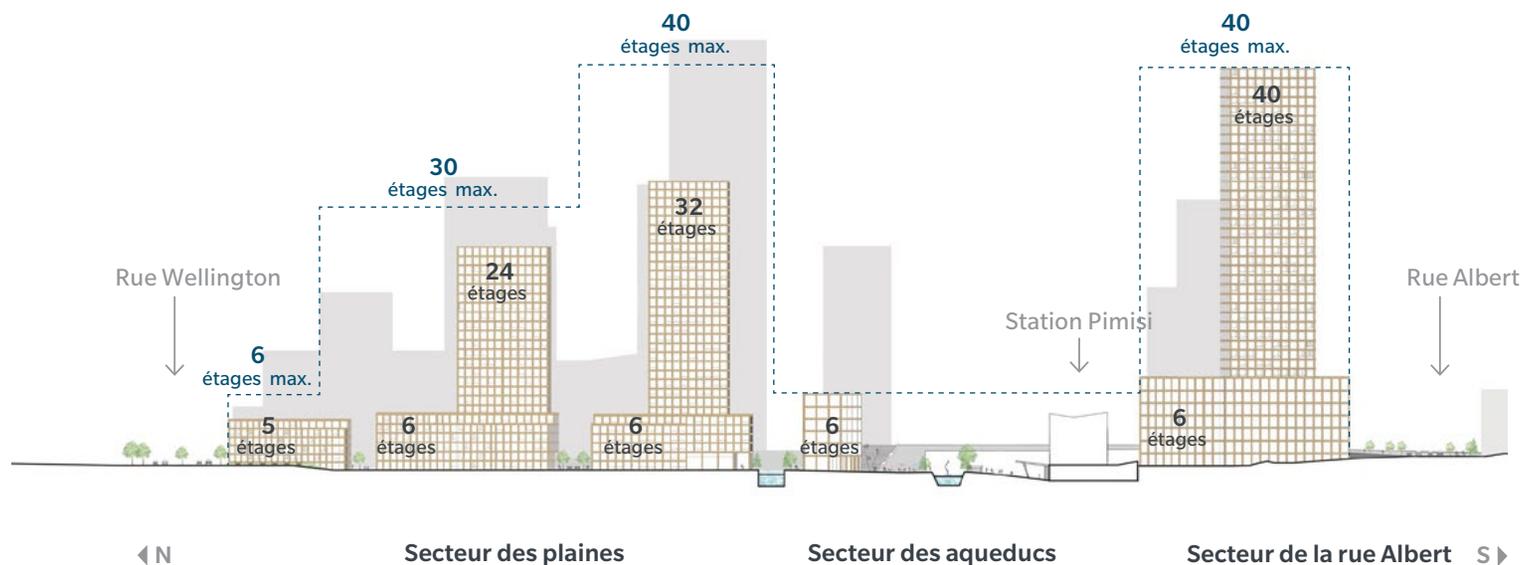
| Élévation (nord-sud) illustrant la transition de la hauteur des immeubles, du secteur des plaines au secteur de la rue Albert
